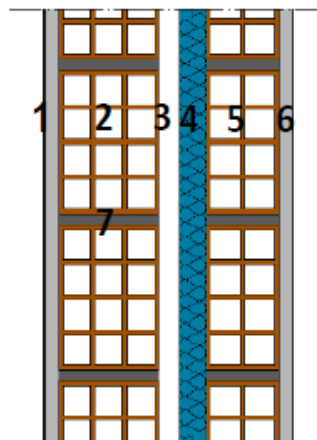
Parede dupla tipo (Adaptado [23])
